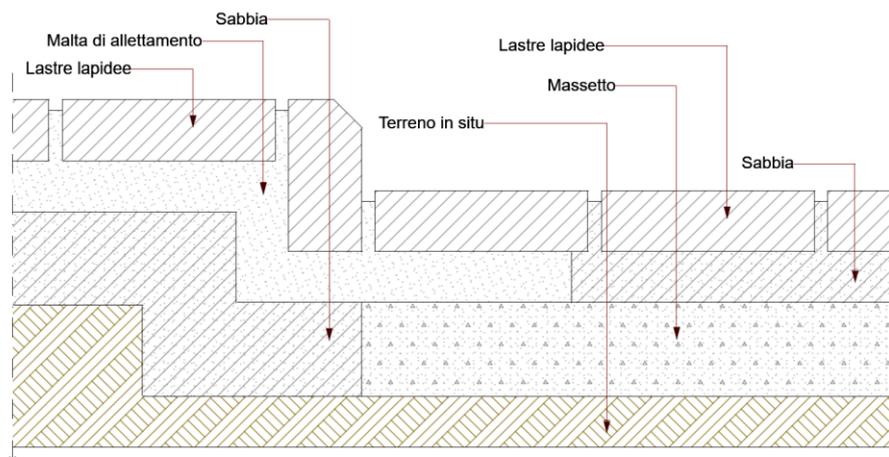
Esempio di pavimentazione carrabile/marciapiede in basolato
